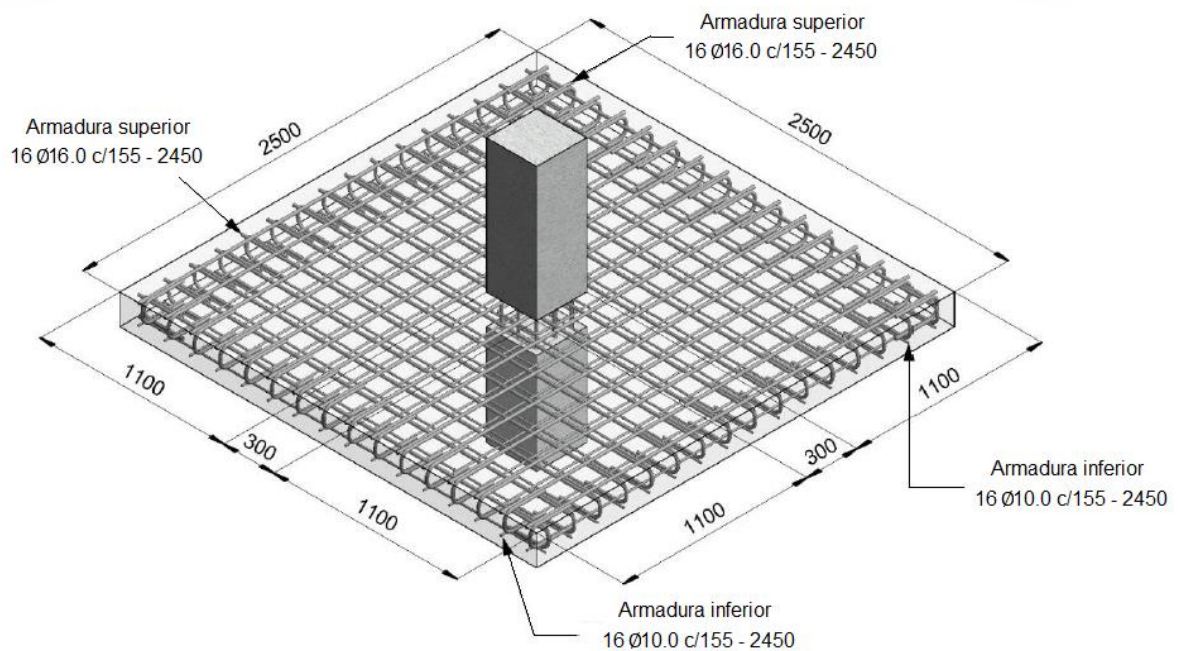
Detalhamento das armaduras longitudinais em perspectiva (unidades em mm)
